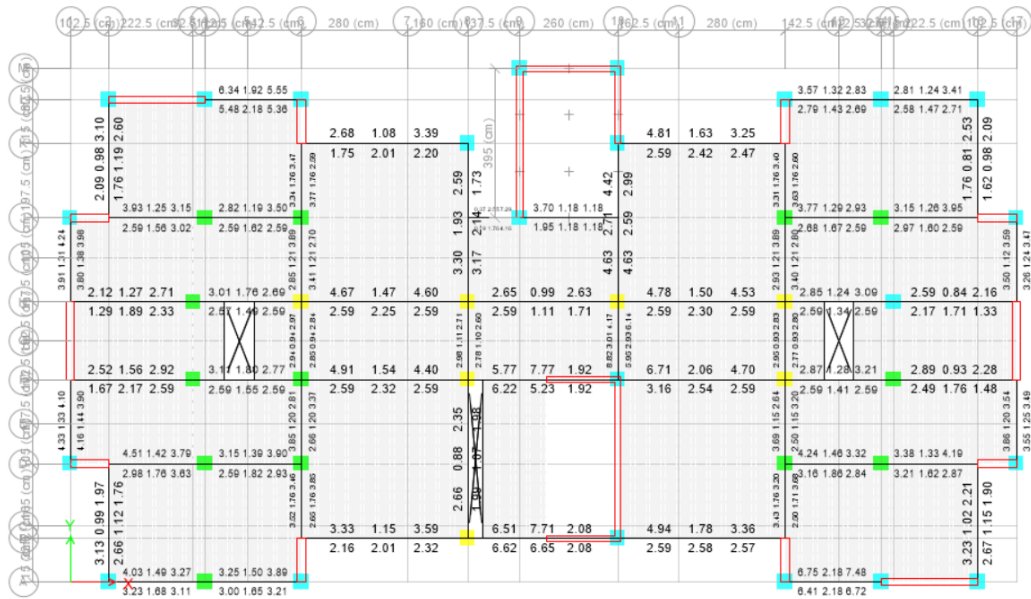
Diseño de acero longitudinal en vigas (Piso 7) Sistema Dual - Edificio Blesser. Fuente: Elaboración Propia.
